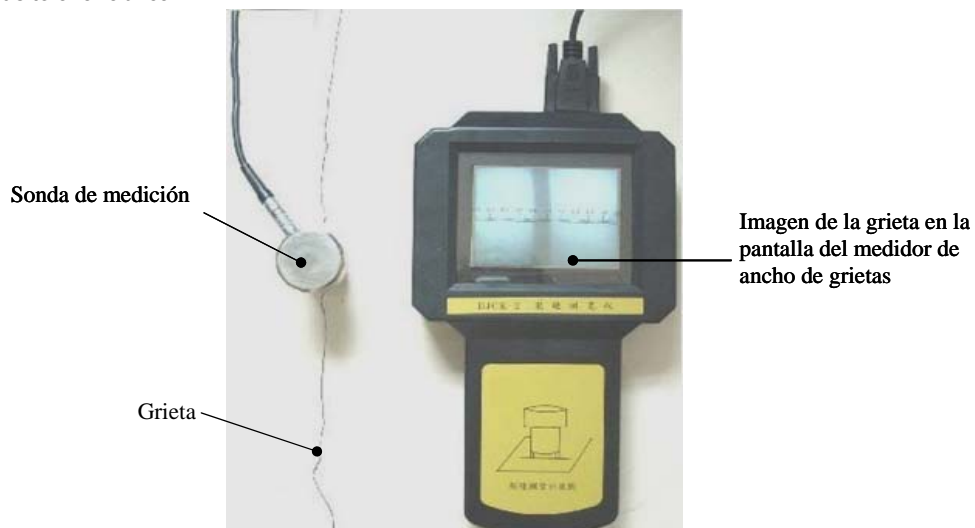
Medidor de ancho de grietas dispuesto para la medición de una grieta.
